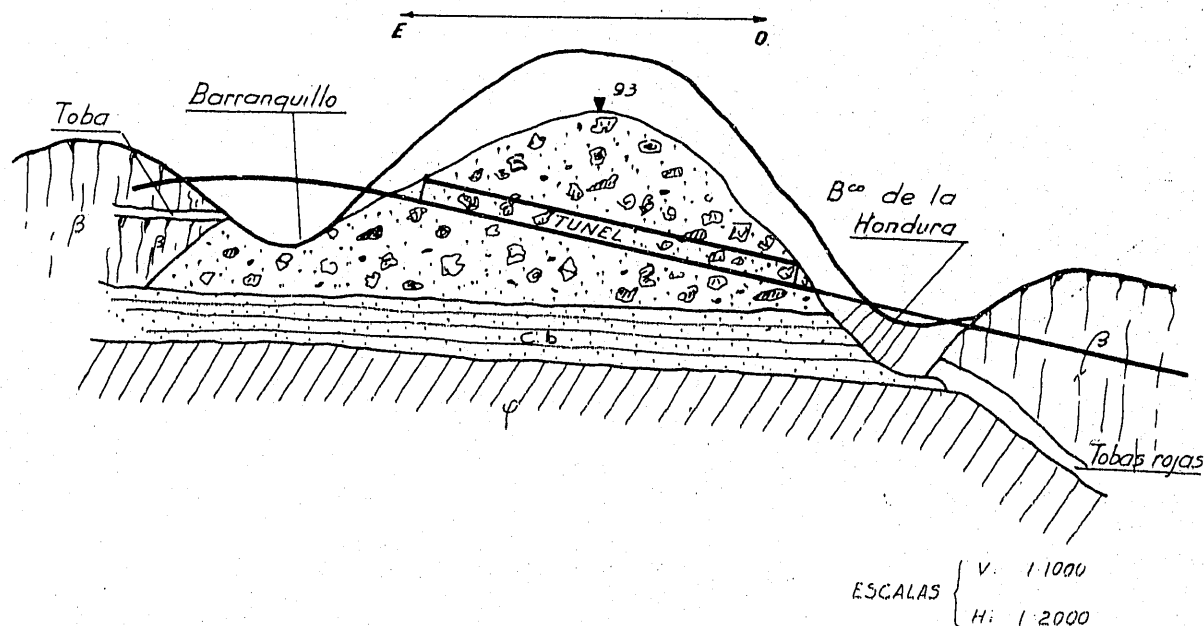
Corte geológico longitudinal G-12, entre perfiles 158-170.
